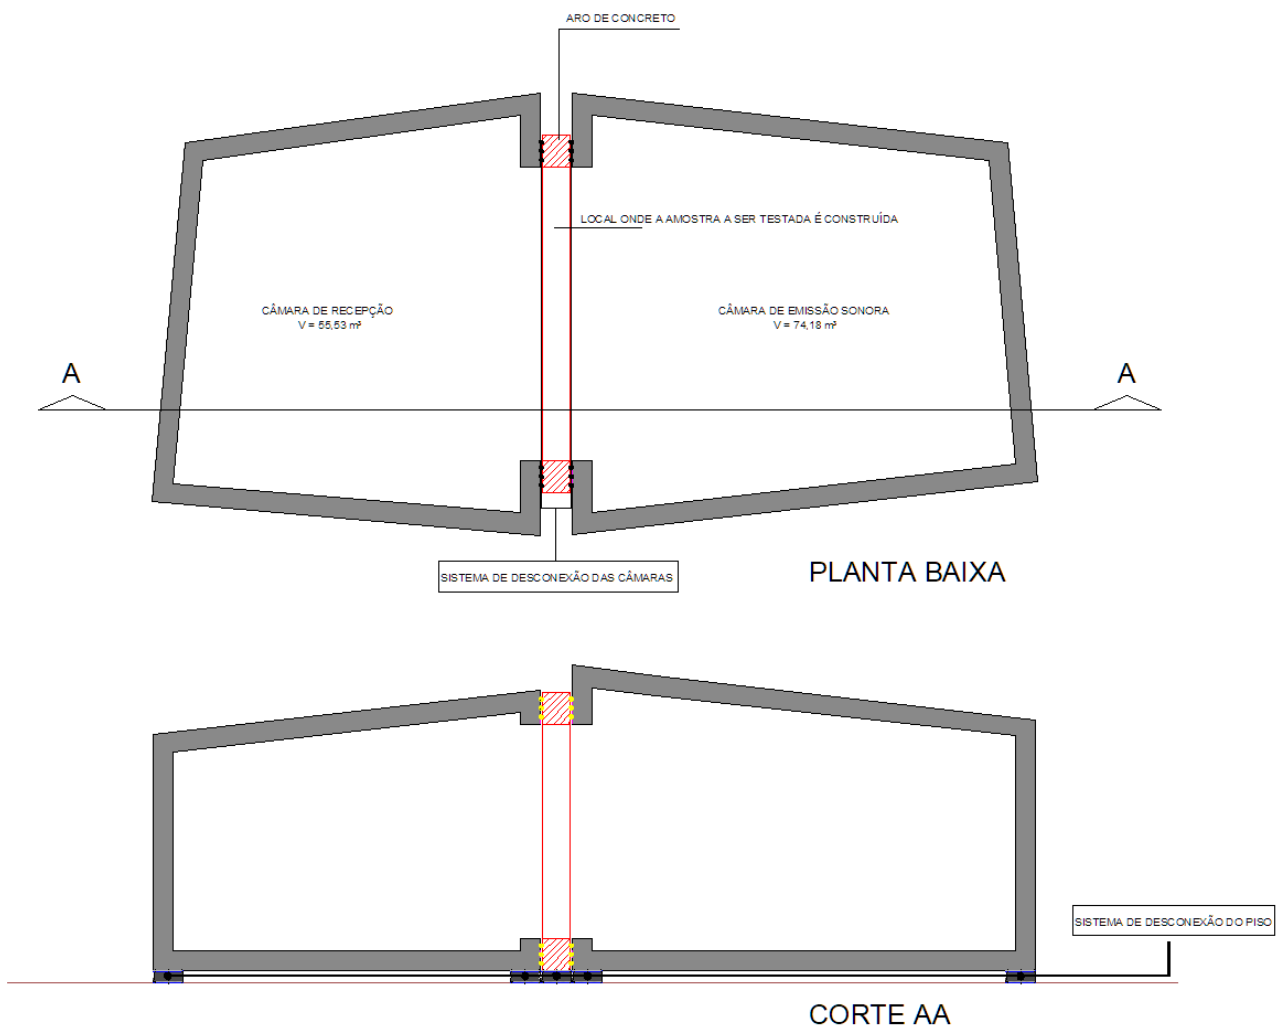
Planta e corte das câmaras reverberantes do laboratório.
